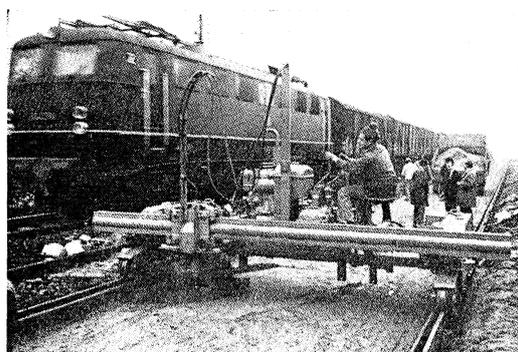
Construcción de una vía de ensayo rápida de los Ferrocarriles Federales Alemanes en hormigón ligero de Styropor, empleado como capa portante y antihielo.
